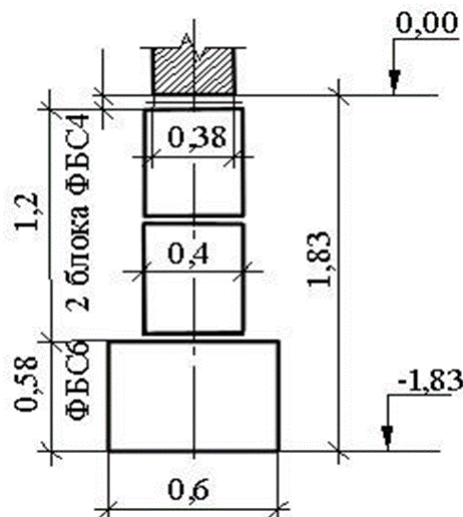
Збірний стрічковий фундамент з плитною частиною та стіновими блоками
